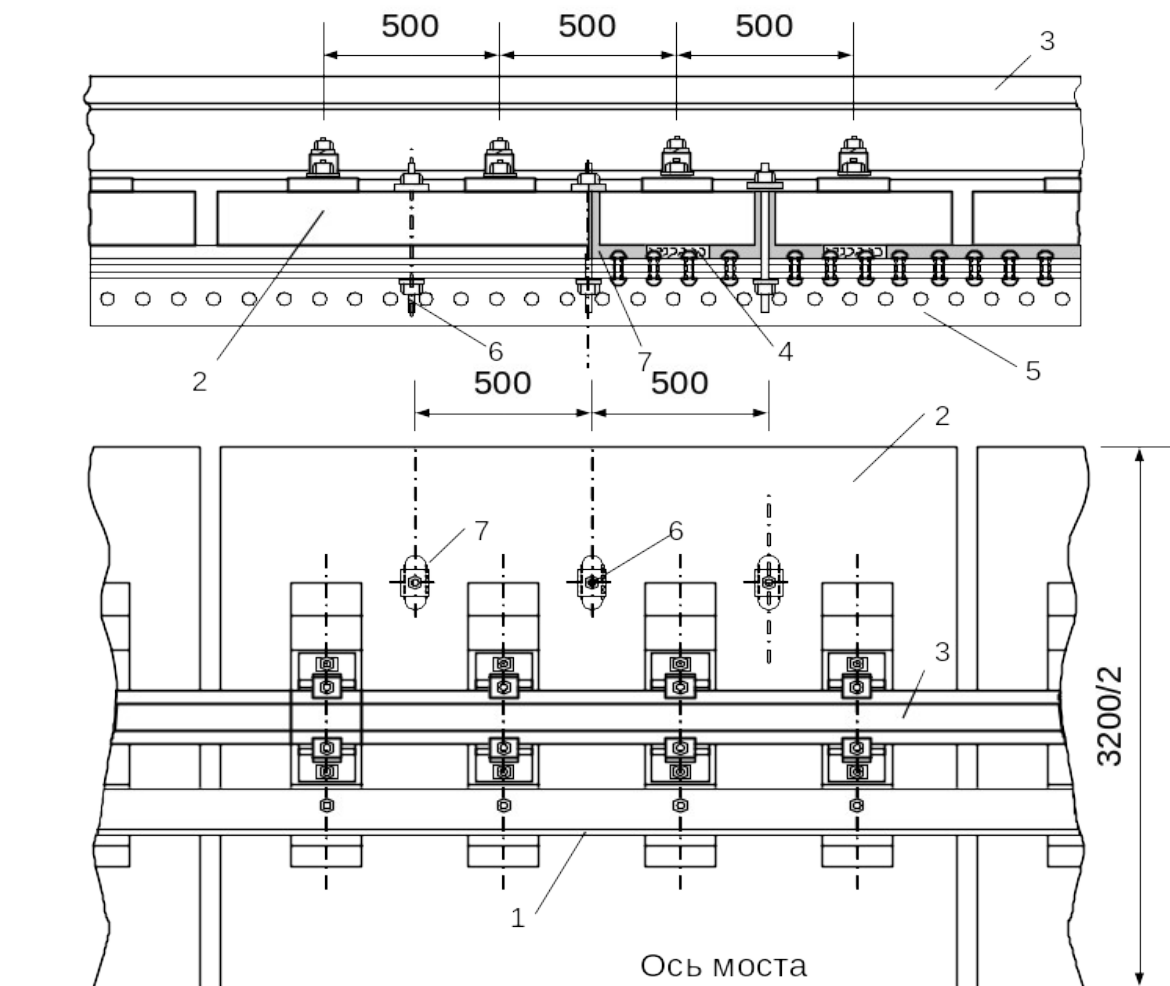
Конструкція безбаластного мостового полотна на залізобетонних плитах:
